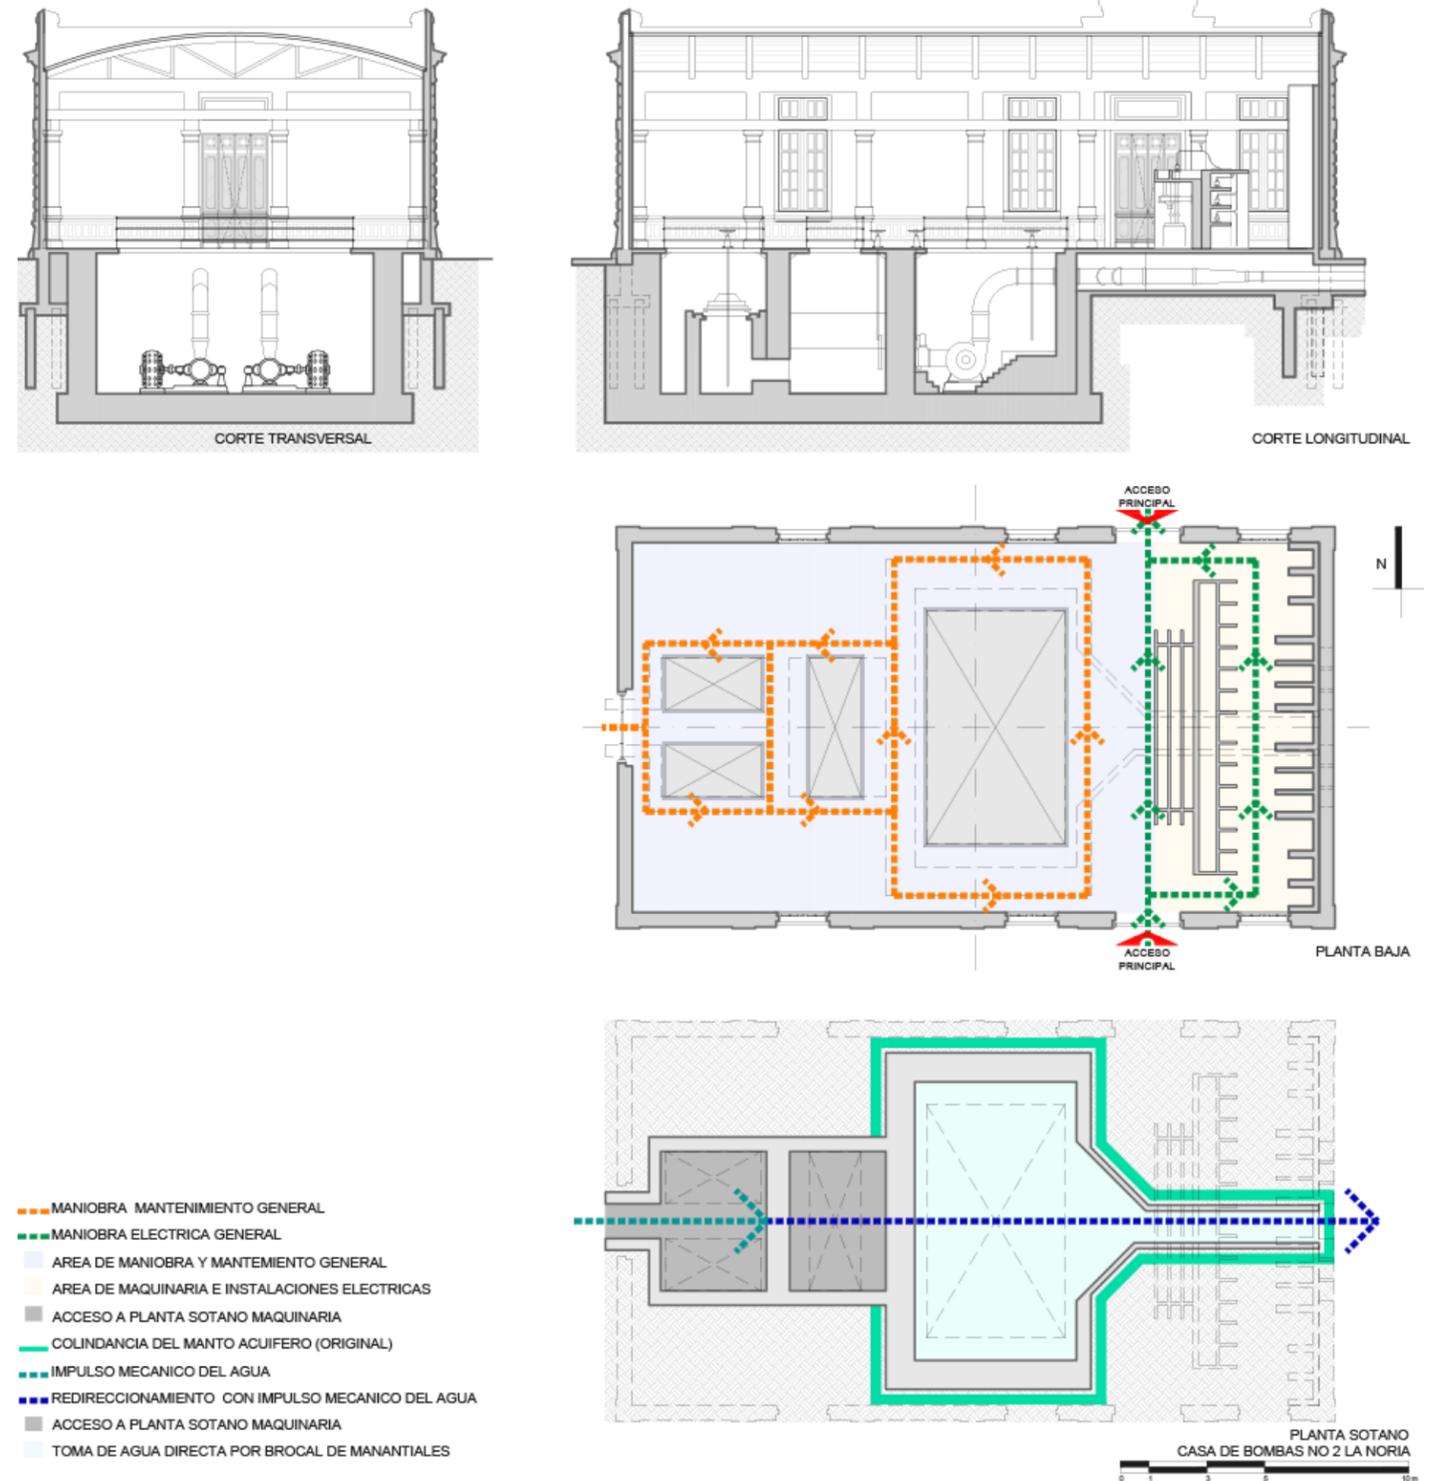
Euroza, Rocio. *Funcionamiento general de la Casa de Bombas no. 2 la Noria*. Febrero de 2021. Plano general. Se presentó la correspondencia formal entre las fachadas y las plantas arquitectónicas.
